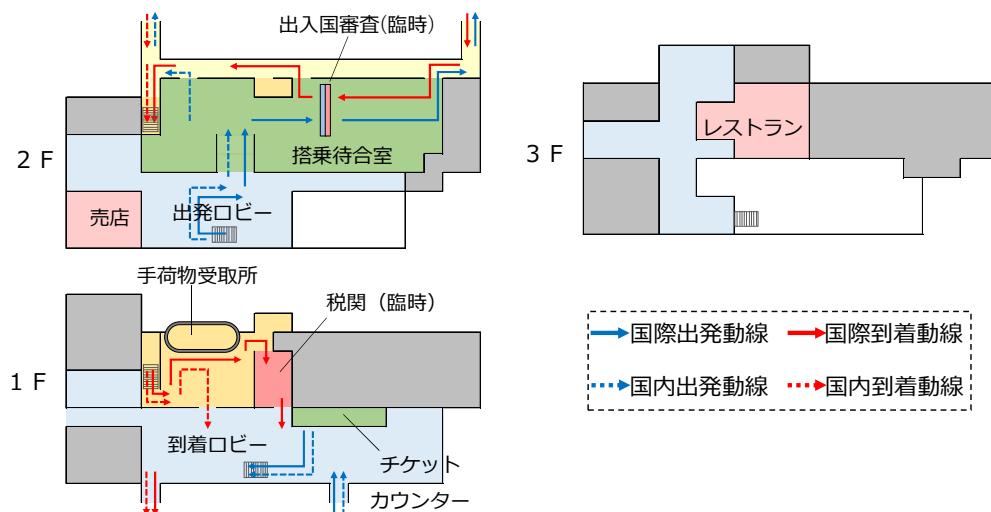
庄内空港ビル現有施設平面図
